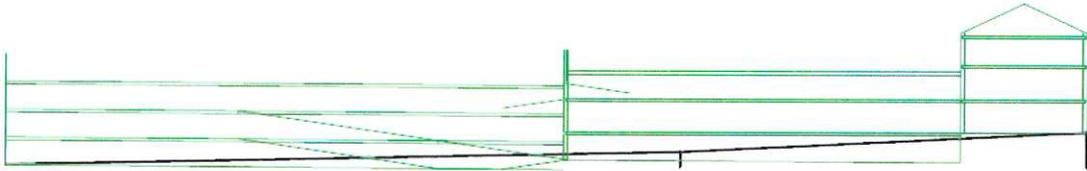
Prinzipschnitt Nord→Süd durch das Plangebiet im Bereich des Parkhauses und des MK-Gebietes
